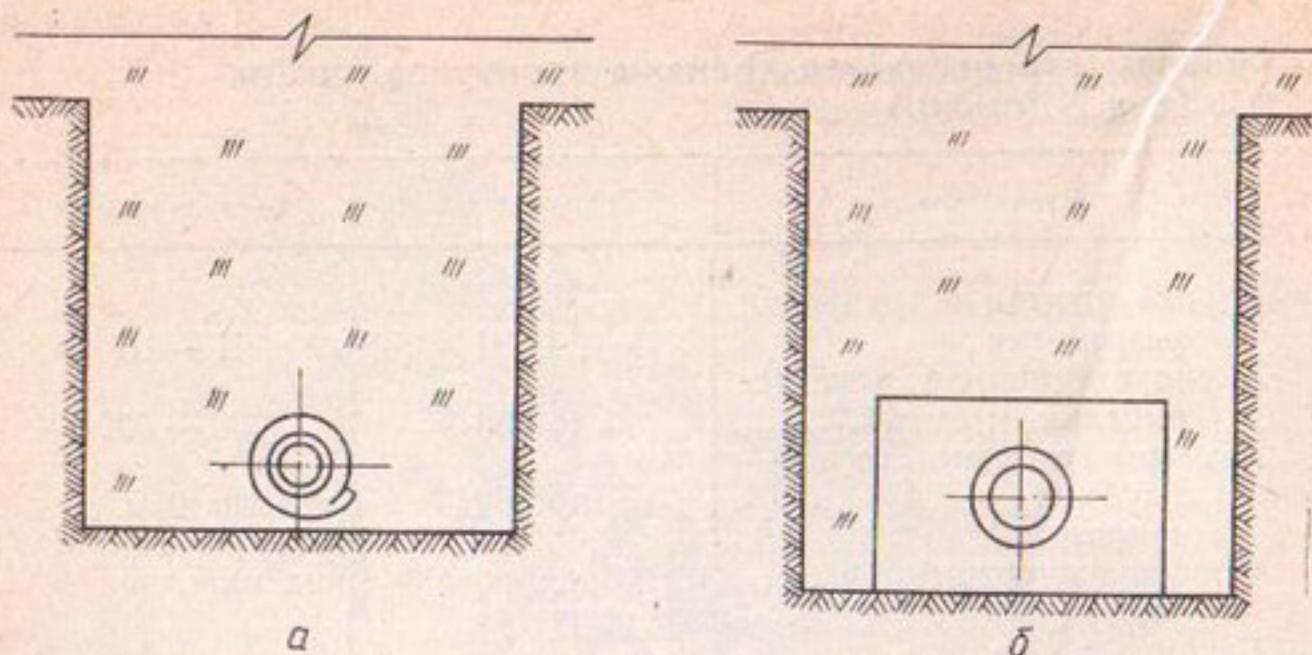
Рекомендуемые конструкции дренажи для бестраншейного способа строительства закрытого дренажа (по Е. Д. Томину):
